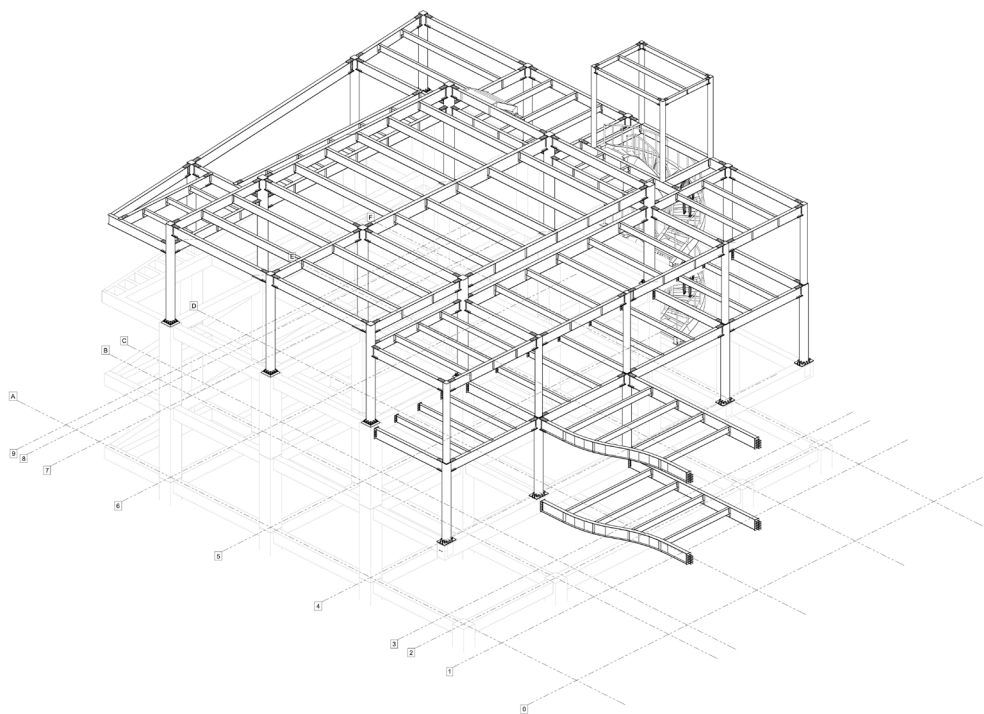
Isométrico de proyecto de oficinas con estructura de acero.
